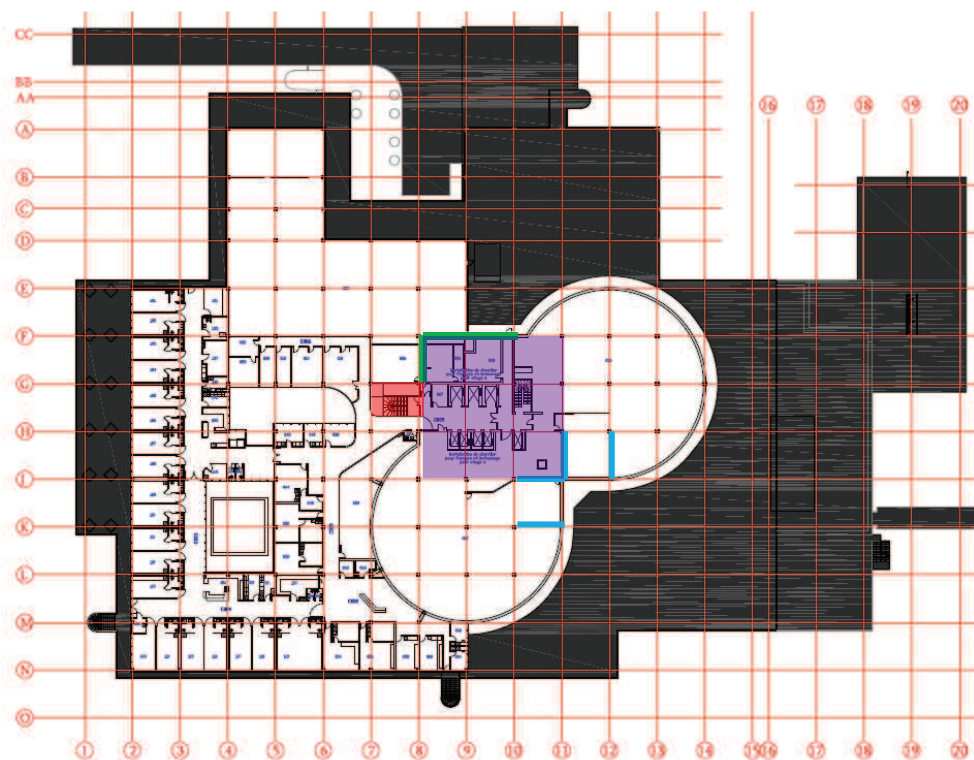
Plan du 2^{ème} étage, niveau C. Nouveaux murs en béton armé.
